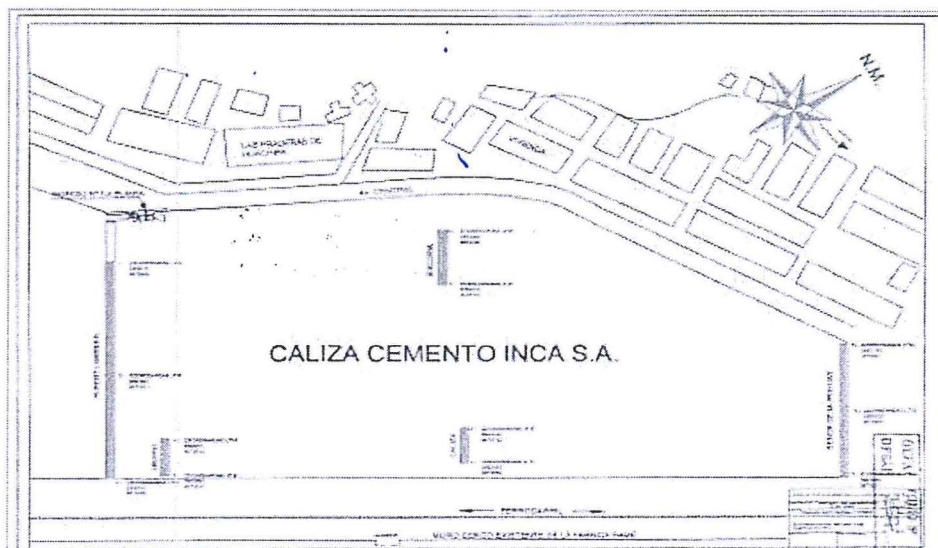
Barreras de separación instaladas en Caliza Cemento
